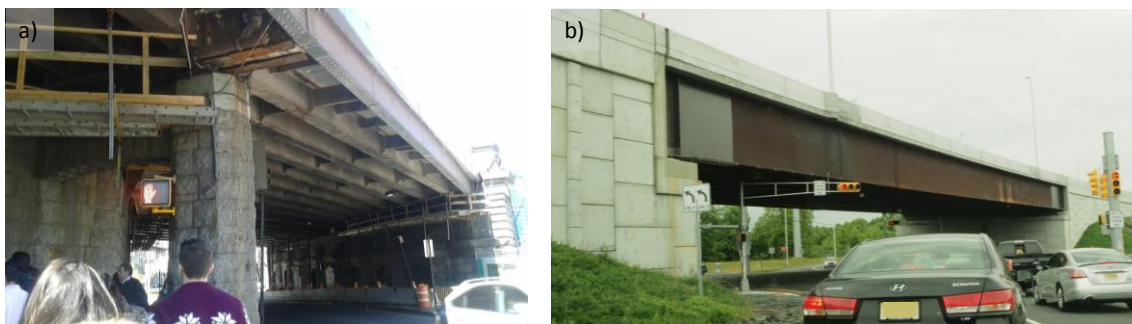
Pasos superiores típicos de vigas metálicas con losa de hormigón armado. a) fuente propia b) fuente: Ignacio Payá-Zaforteza
